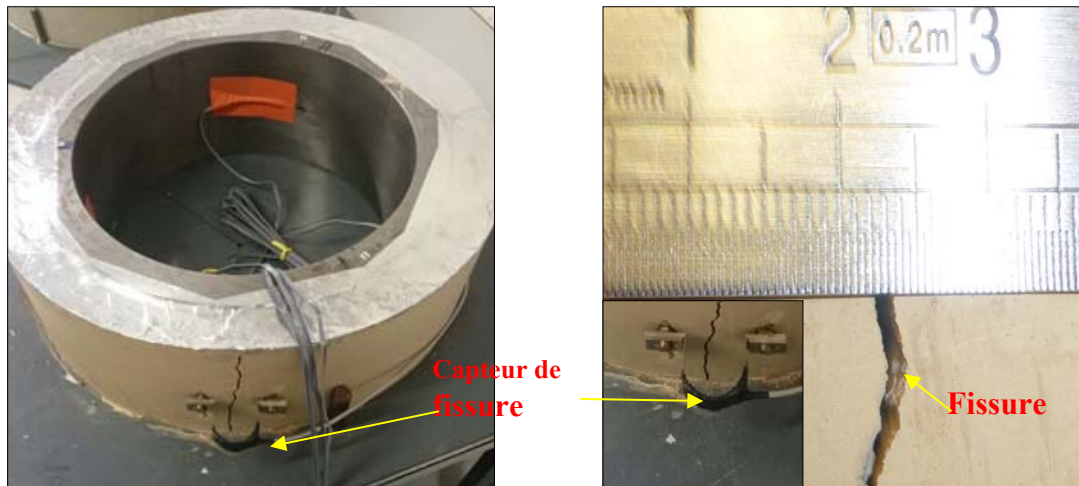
La fissuration de l'anneau du mortier avec l'installation du capteur de fissure
